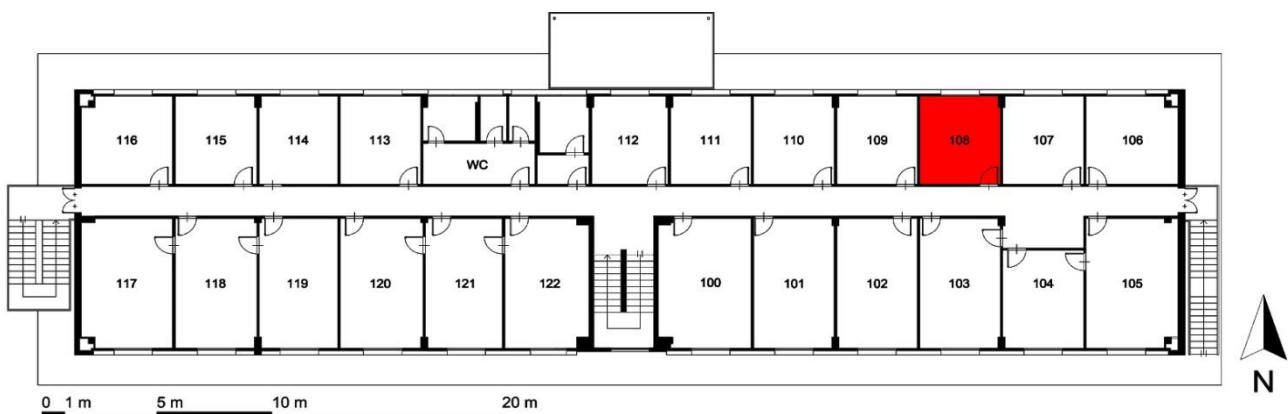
Planimetrica dell'edificio F51 del Centro Ricerche Casaccia dell'ENEA.
